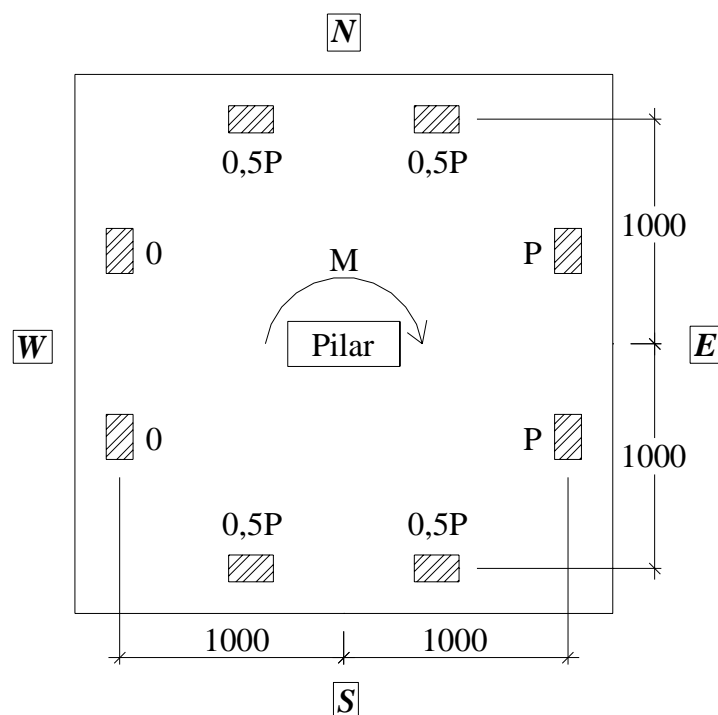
Carregamento das lajes L8, L10 e L14 (dimensões em mm)
